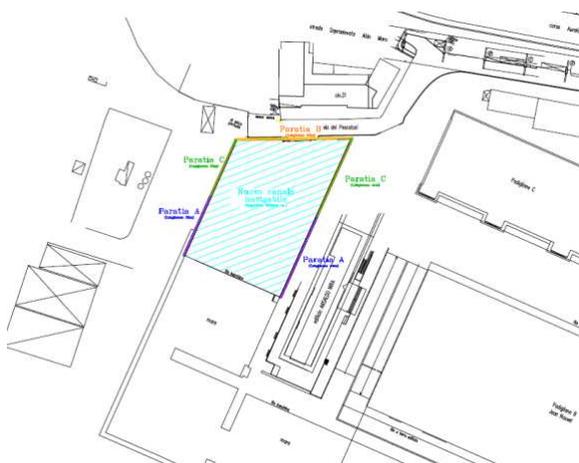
Planimetria Imbocco Canale navigabile
